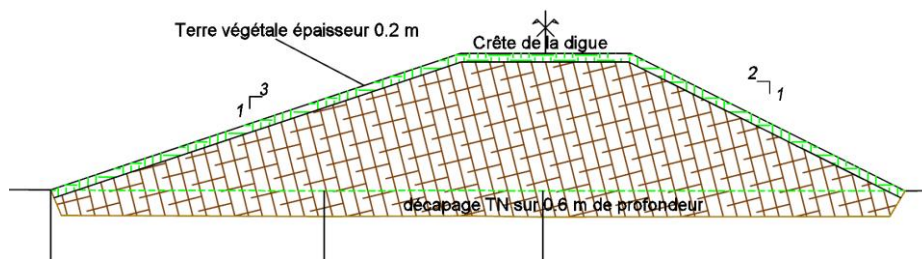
Coupe type sur section courante (ARTELIA, 2021)
